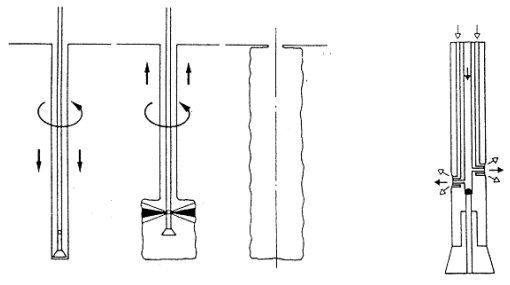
Jet Grouting - ar e calda de cimento - Tipo 2 [20]
